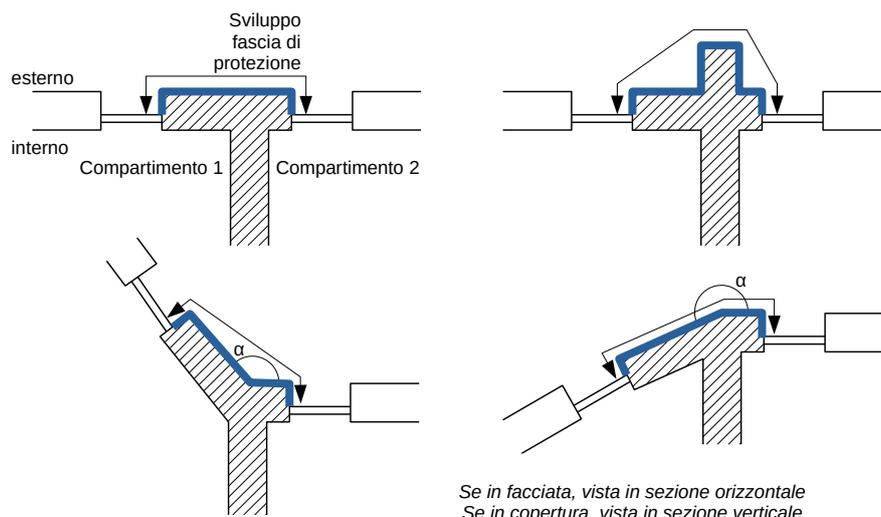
Fascia di separazione verticale in facciata o in copertura
